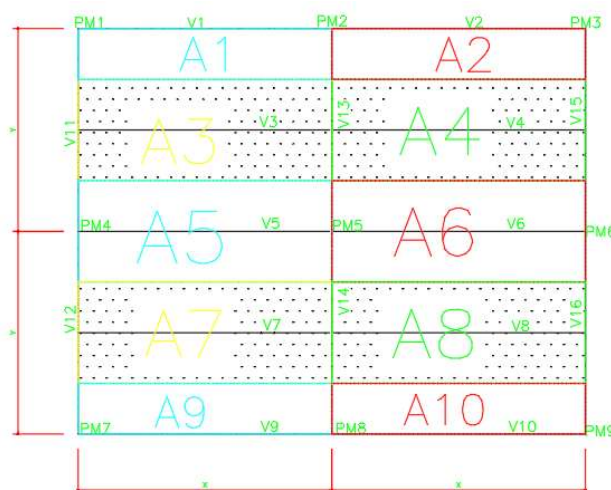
Representação das áreas de influência das lajes, em laje steel deck.
